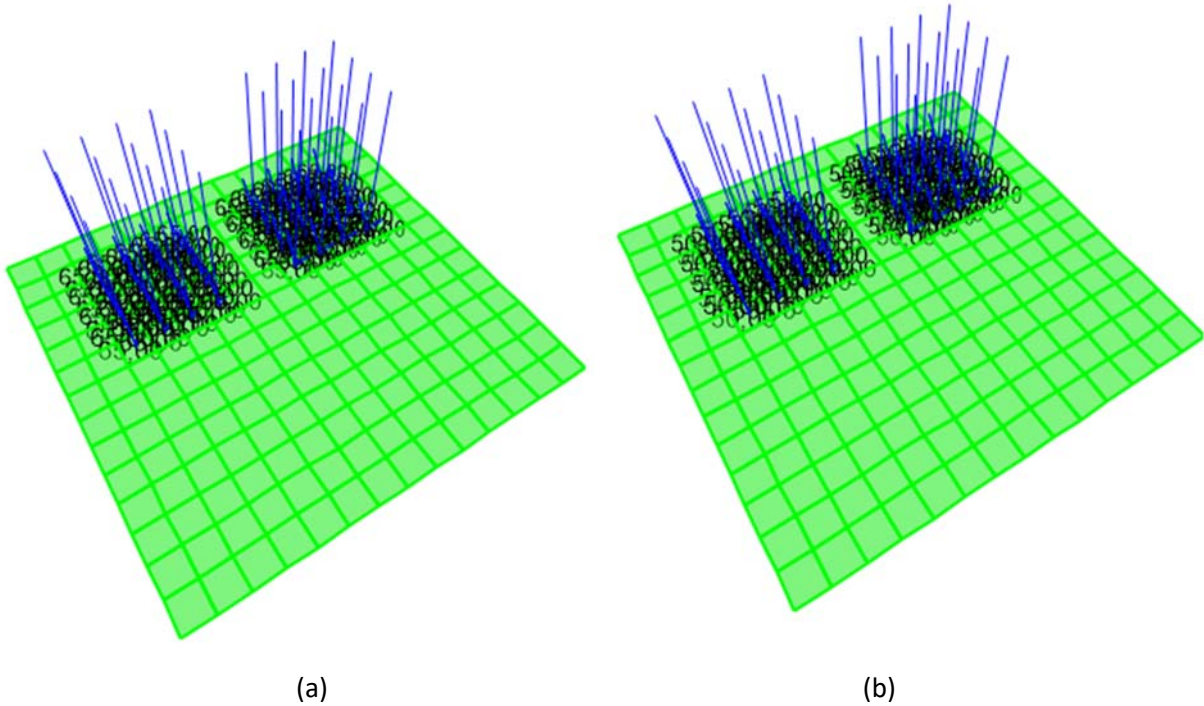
Tettoia locale soffianti. Carichi indotti dalle soffianti in combinazione SLU (a) ed SLE (b).
